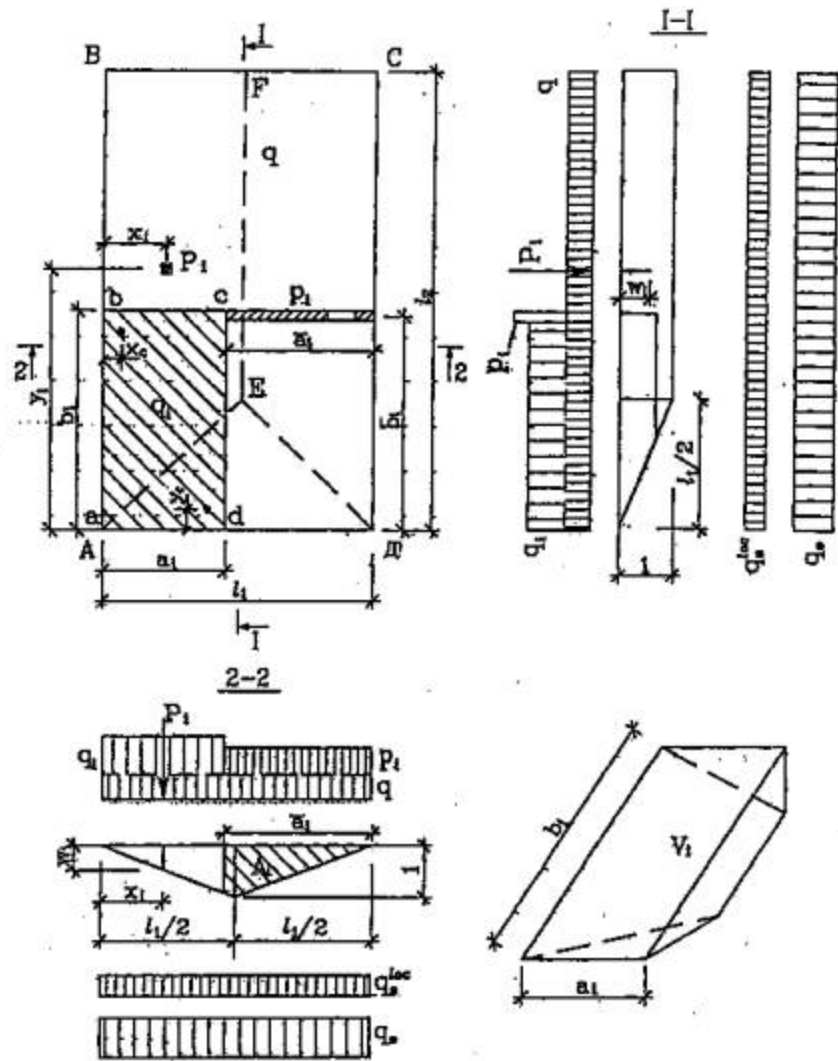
Схема определения эквивалентной нагрузки в плитах, опертых по трем сторонам, при локальных нагрузках, удаленных от свободного края BC:
